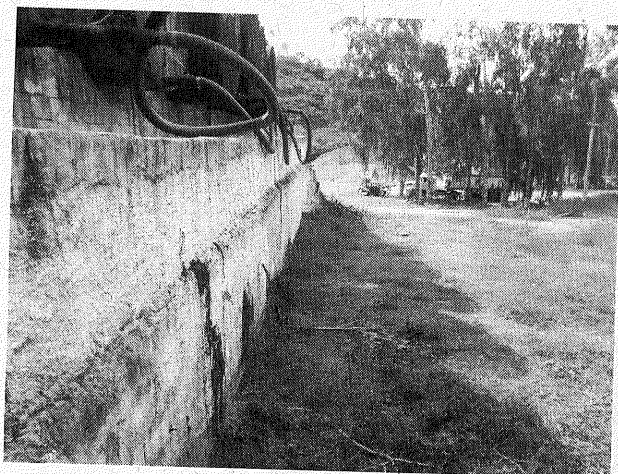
Área de descarga dos novos tanques de emulsão com piso não concretado.
